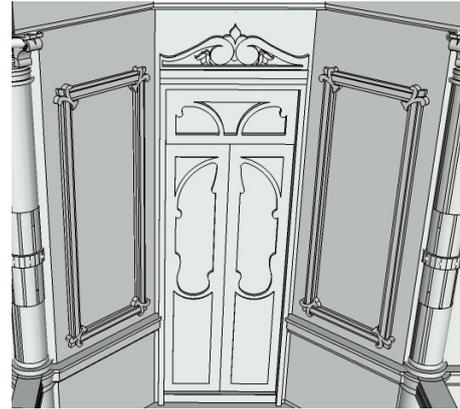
| Detalhe da porta de entrada. FONTE: Autora, 2017.
